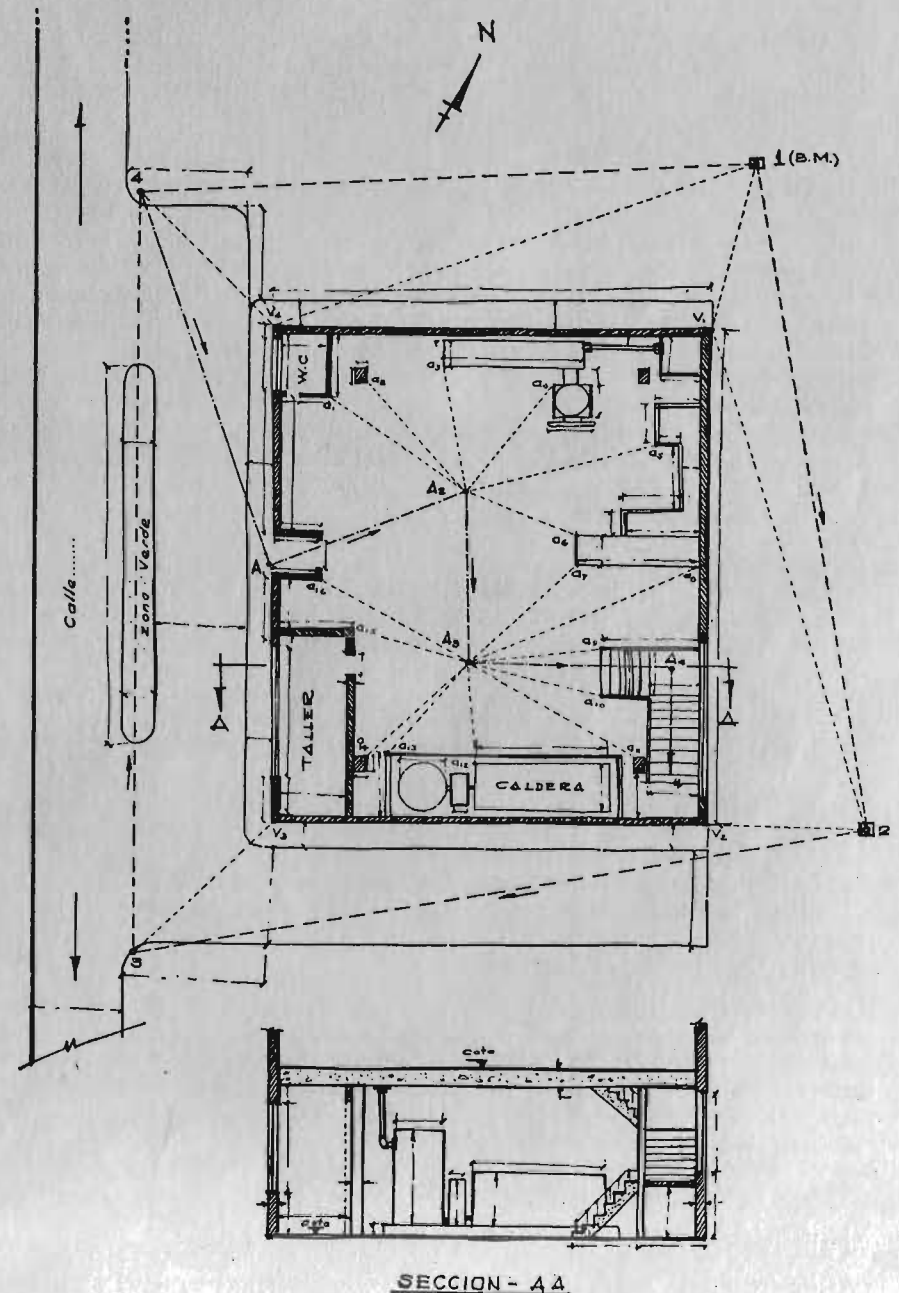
Esquema preliminar (a mano alzada) a un levantamiento de una edificación
